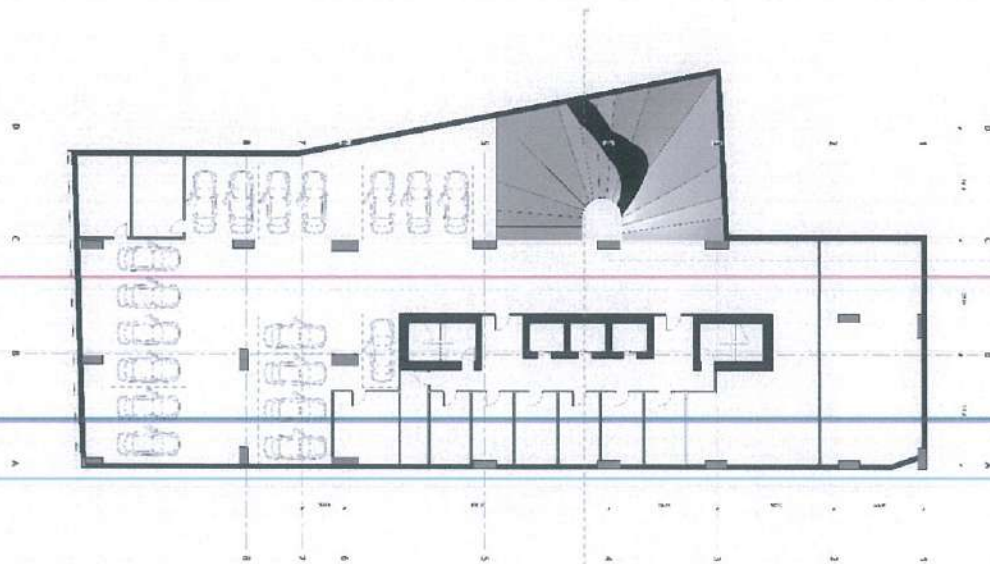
Plani i katit -2,-3,-4,-5 tip, me funksion parkim
